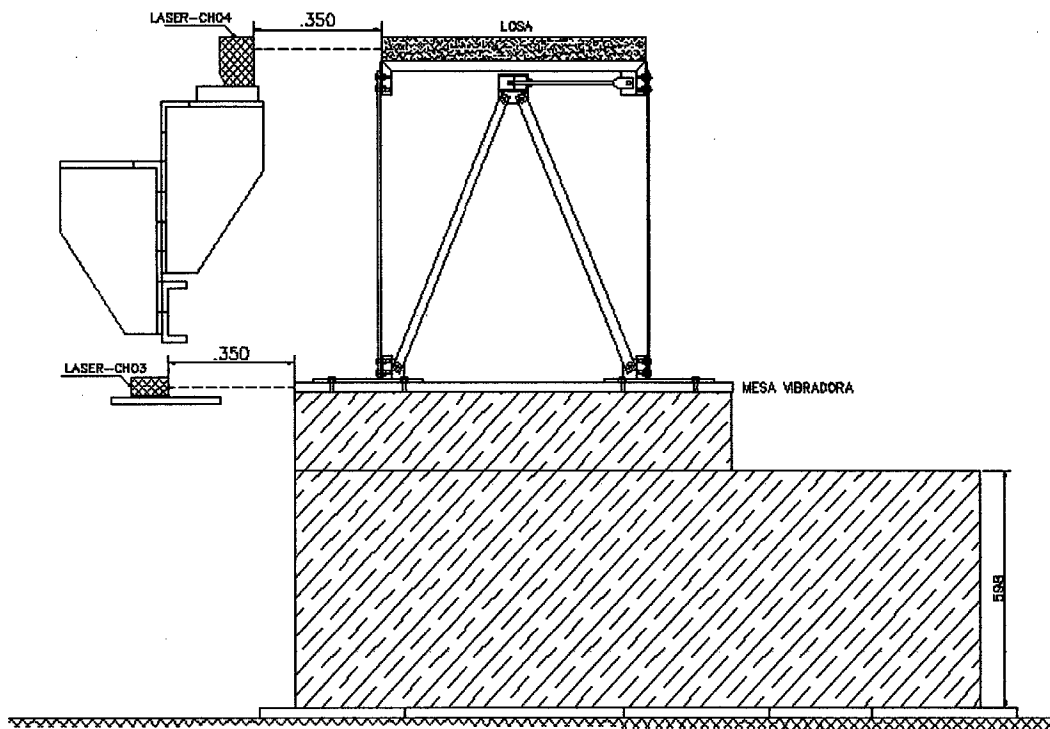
Sección A-A ubicación de sensores (dimensiones en metros)
